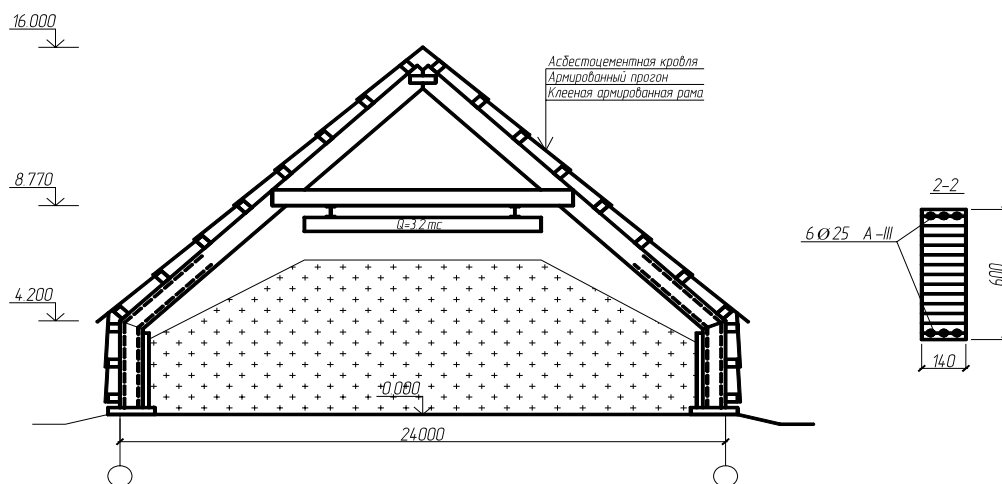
Клееные армированные конструкции здания прирельсового склада минеральных удобрений
